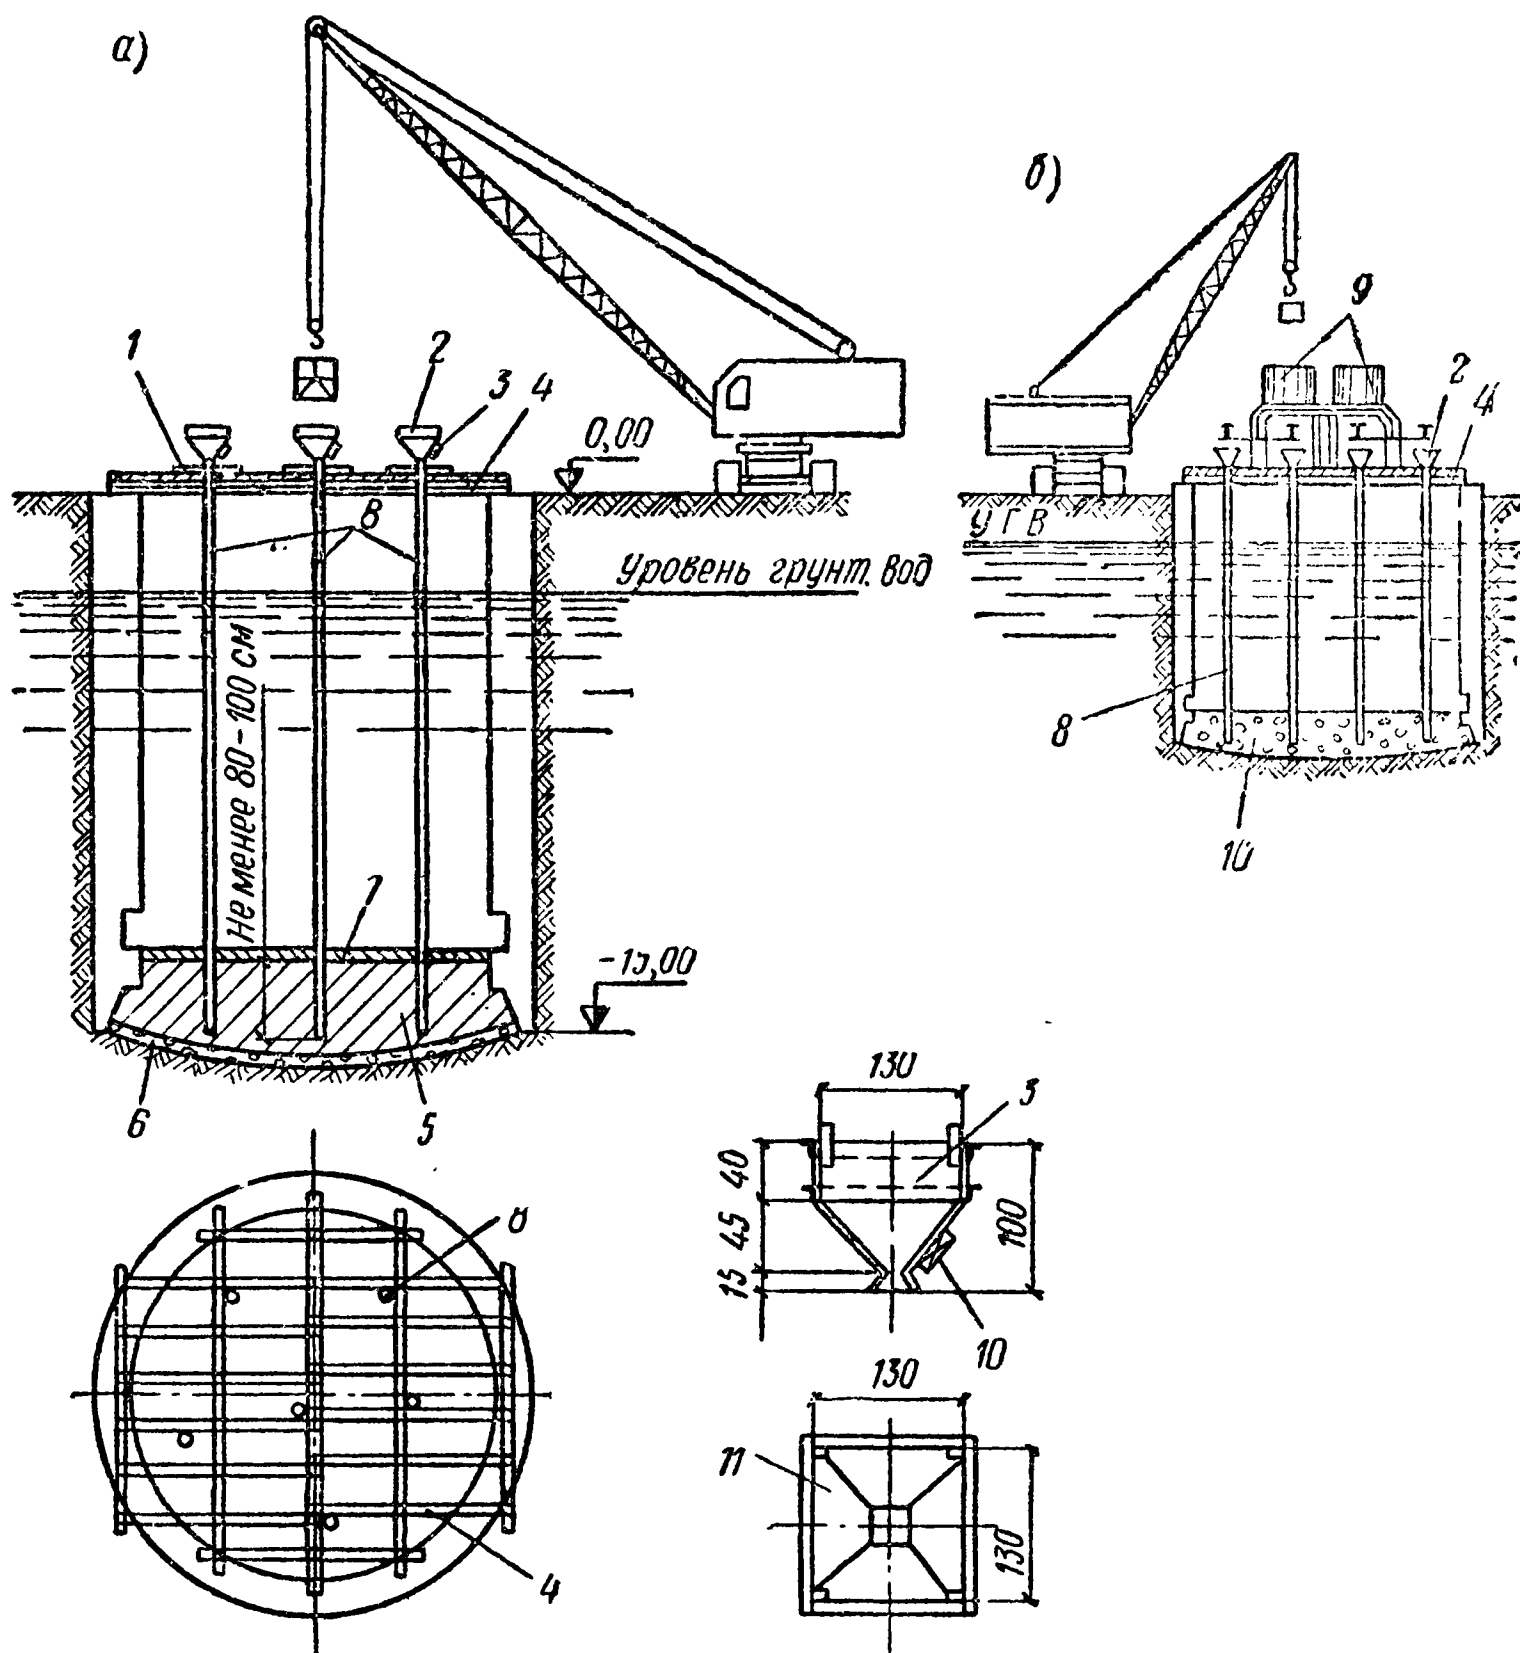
Схема подводного бетонирования дна опусного колодца
